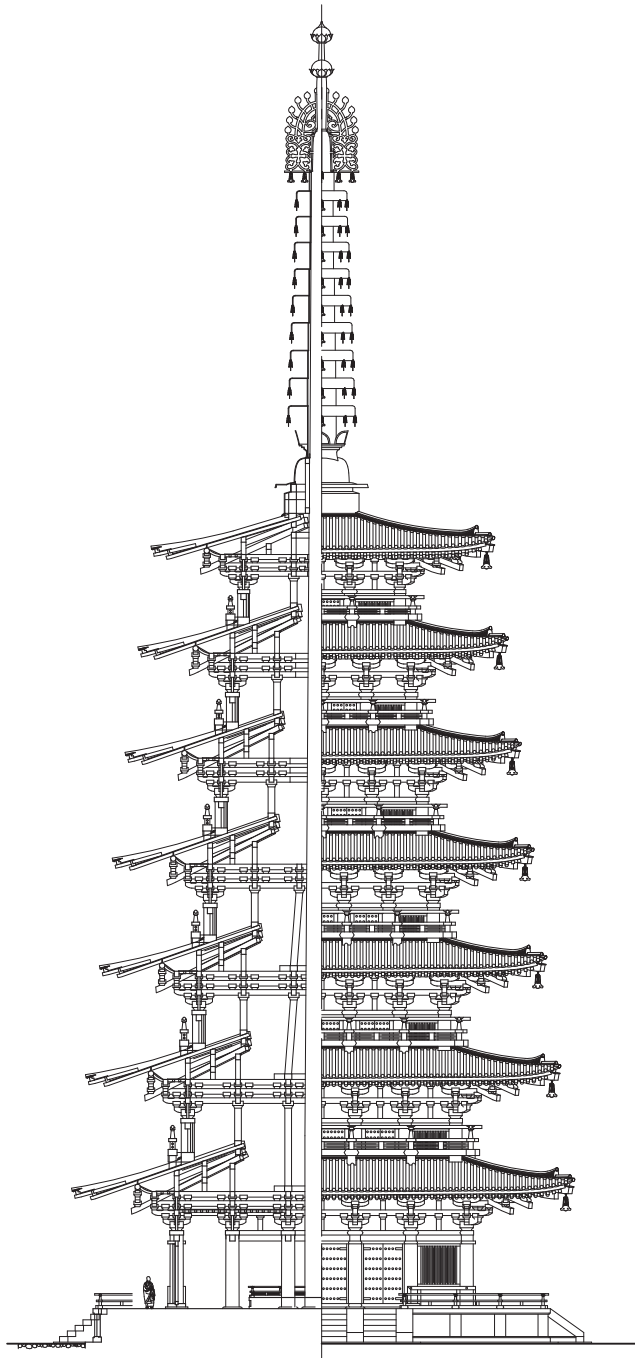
天平塔 (奈文研 2024 案) 立断面图 1 : 400
